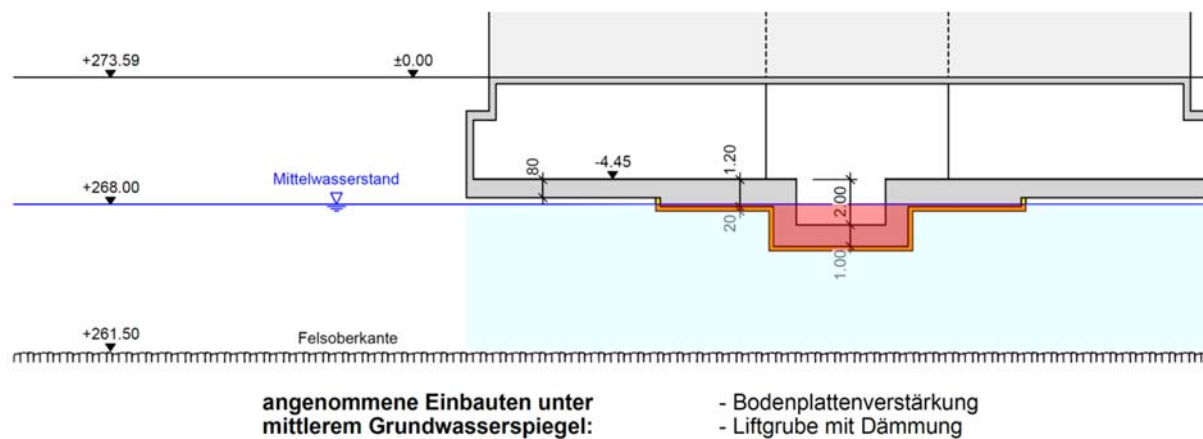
Ausschnitt Plan der Einbauten ins Grundwasser
